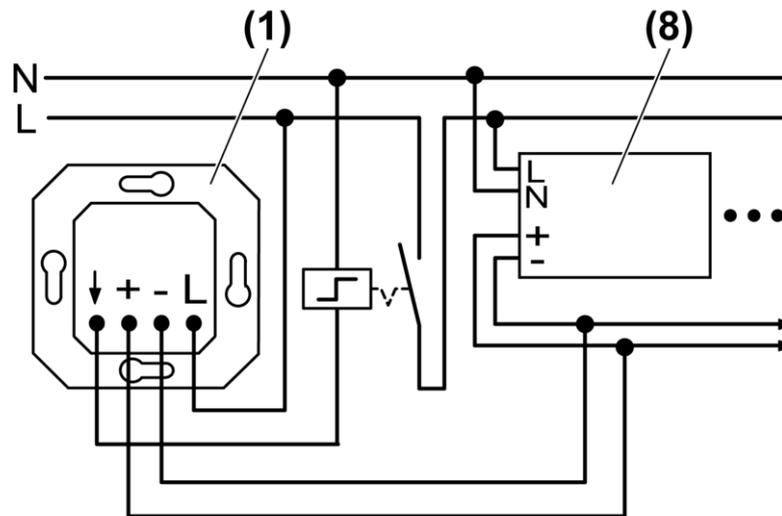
Schema di collegamento del potenziometro con funzione di sensore
